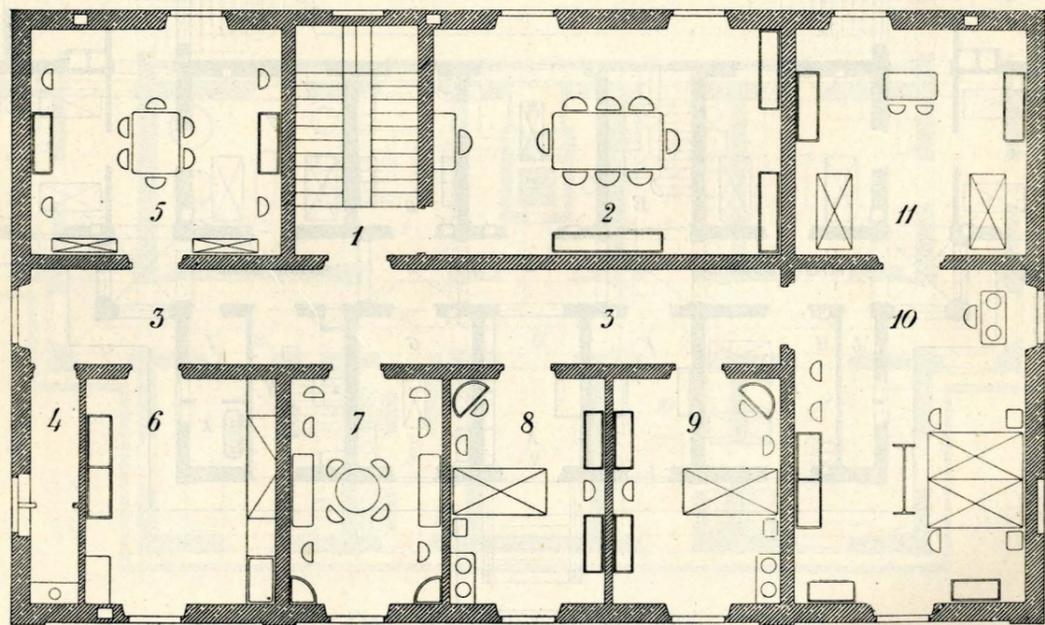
Pianta del primo piano superiore del corpo centrale (Scala di 1:170).
